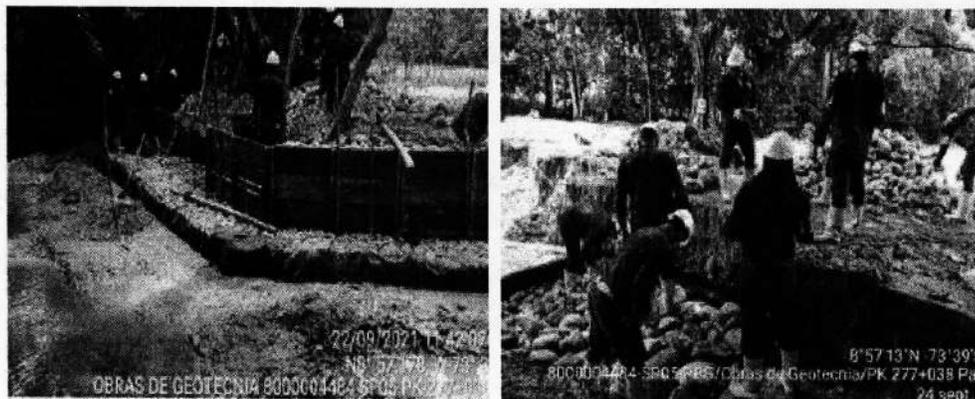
Construcción de colchoneta reno y muro en gavión de un nivel en margen izquierda de quebrada La Morrocuya
